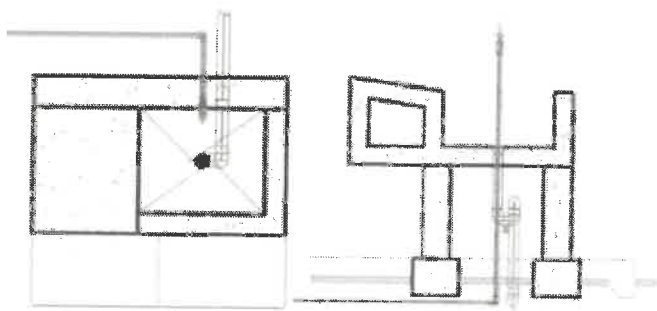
Planta y elevación de arquitectura y sanitarias de lavadero multiusos del sector Santa Rosa del caserio de Cajás Shapaya.
